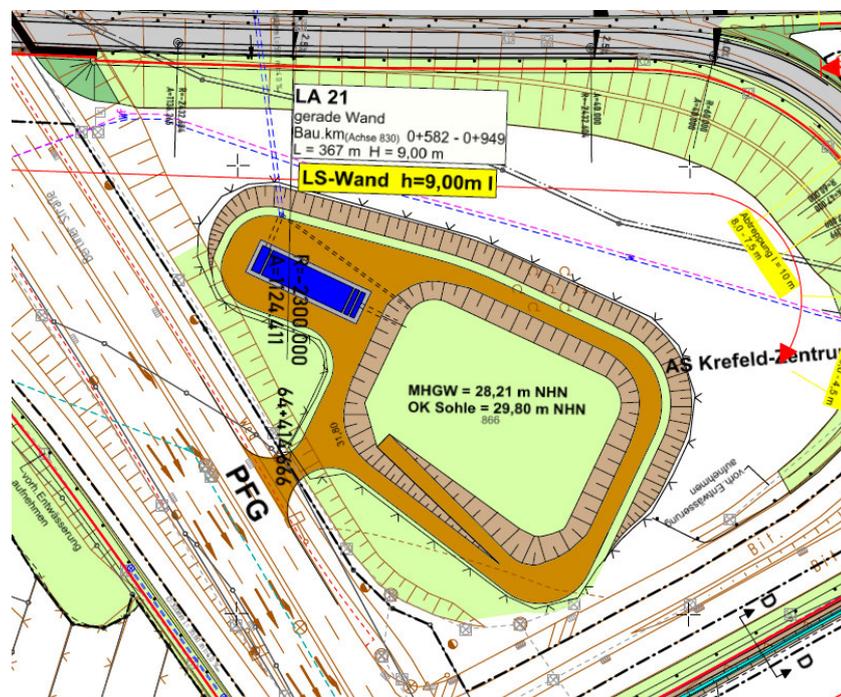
Lageplanausschnitt Regenwasserbehandlungsanlage Zentrum
